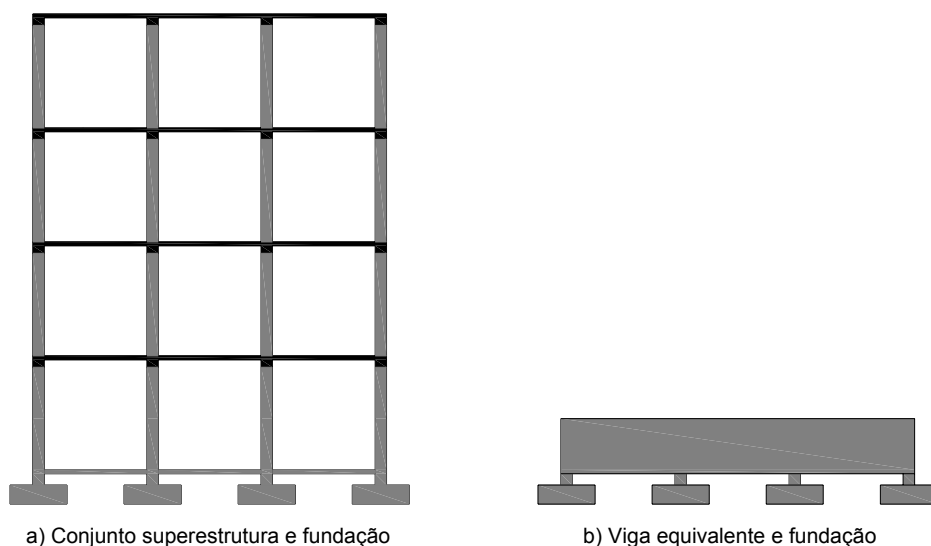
Consideração da estrutura como uma viga de rigidez equivalente (MEYERHOF, 1953)
